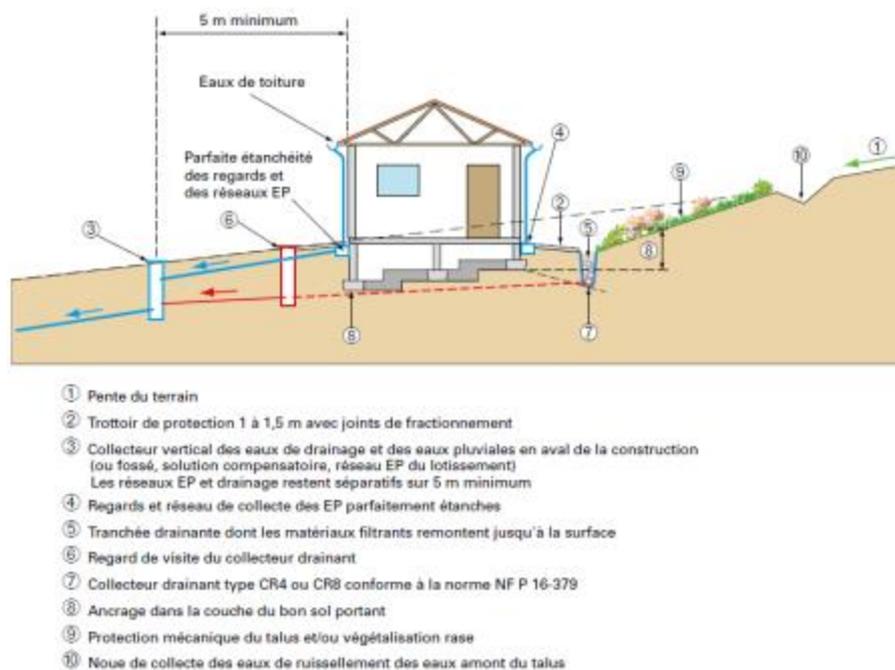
Coupe sur les ouvrages de collecte des eaux pluviales séparés du réseau de drainage déporté. Extrait du guide AQC-CSTB « Pathologie des fondations superficielle ».
